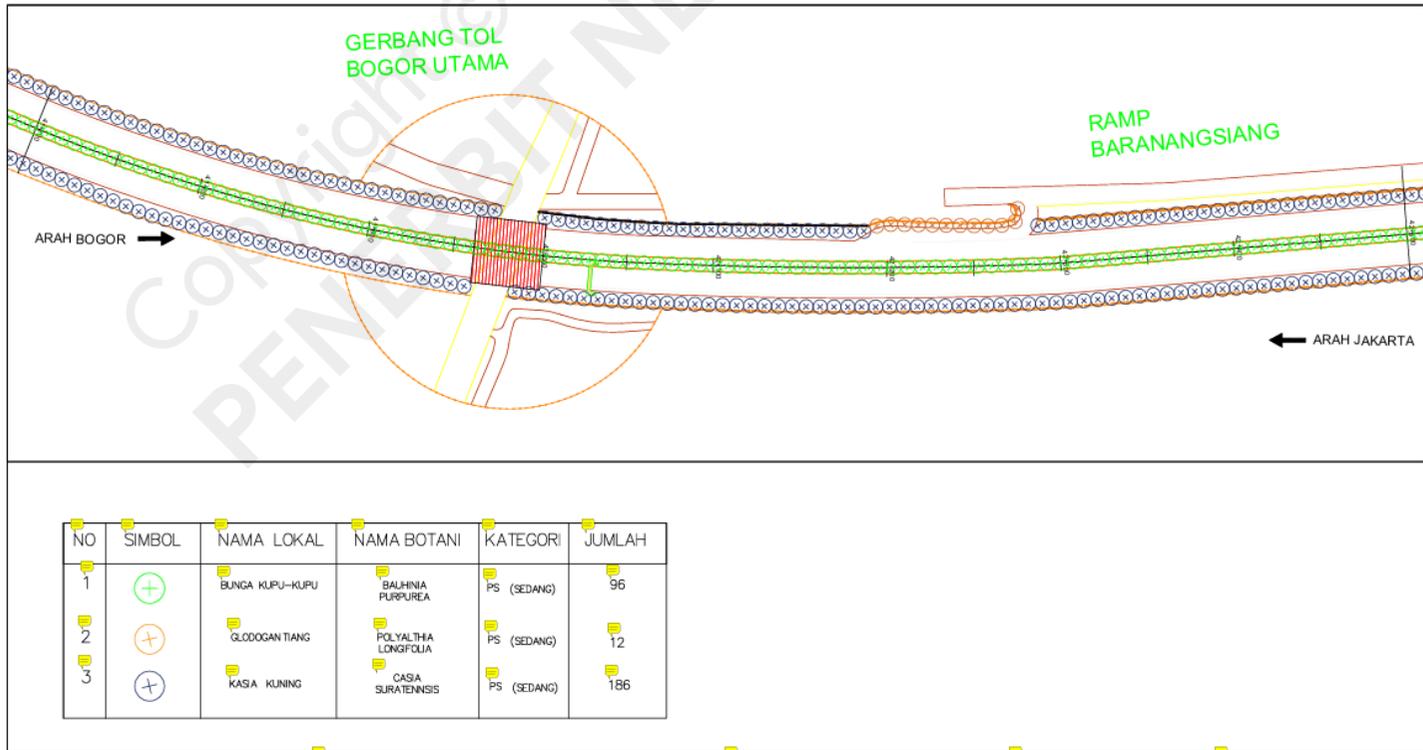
Rencana RTH pada Ruas Km 40,3-41
